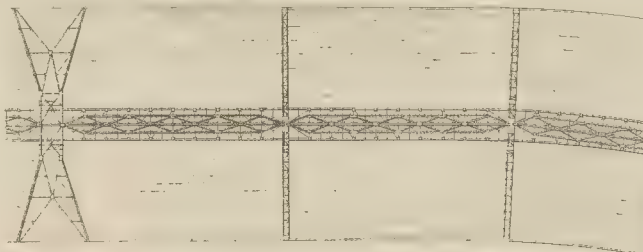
Vista en plano de las construcciones levantadas sobre el río Wupper
